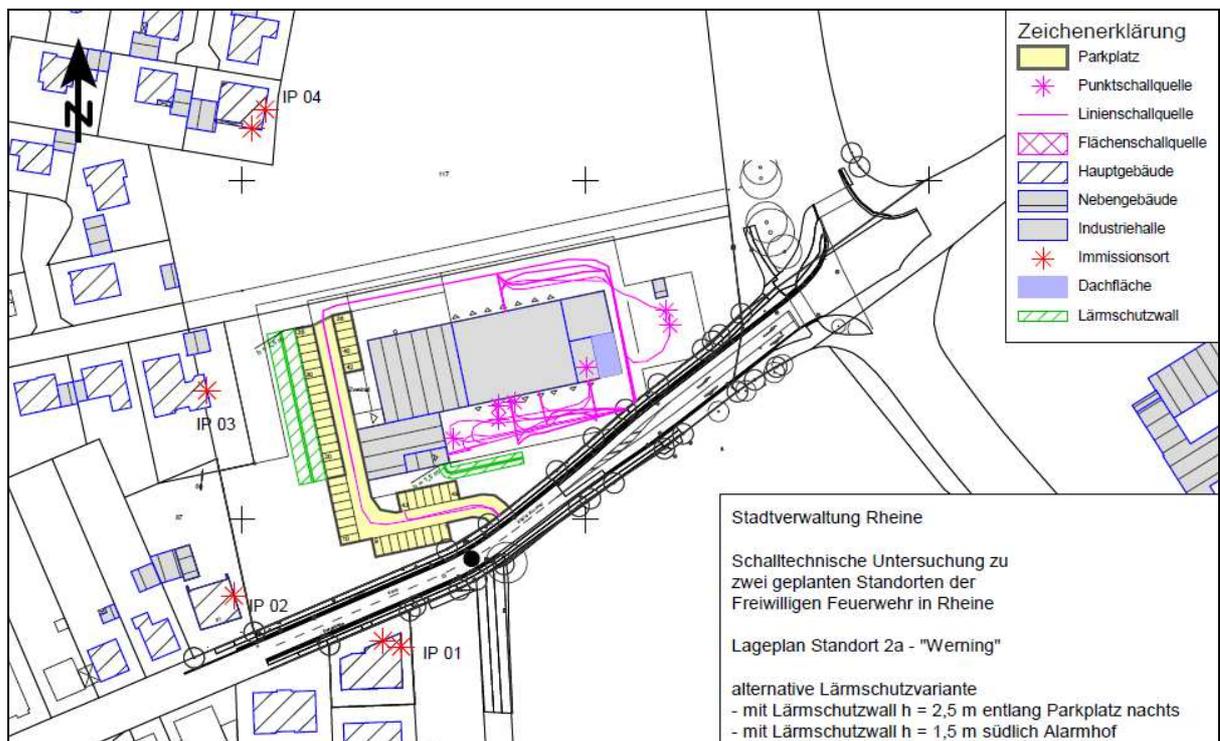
Lageplan zu den hier beispielhaften Lärmschutzmaßnahmen (Büro Zech, Lingen)
